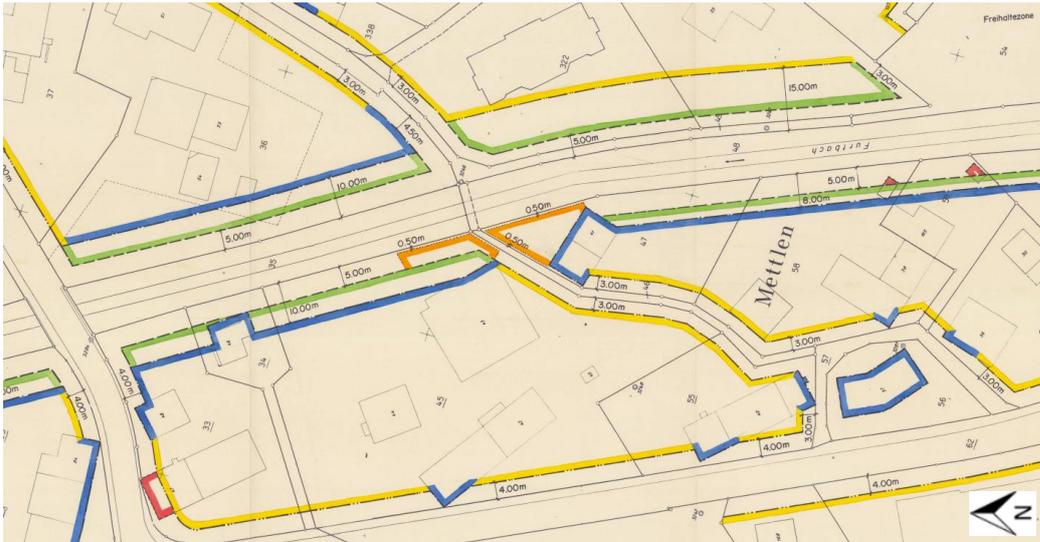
Planausschnitt BLP 'Weinfeldferstrasse, Märwilerstrasse und Furtbach' 1994
